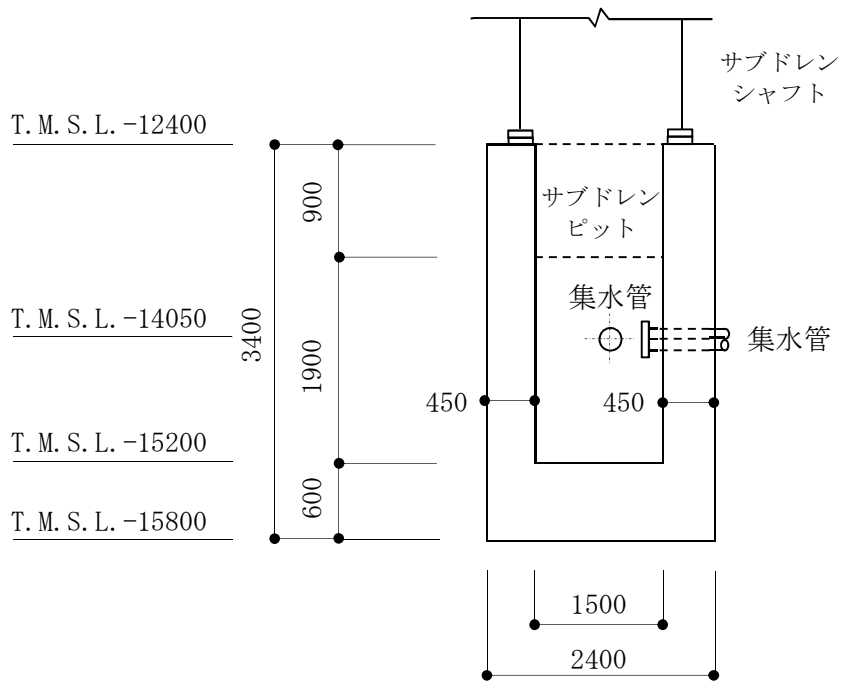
原子炉建屋サブドレンピットの概略断面図 (A-A断面) (単位 : mm)
